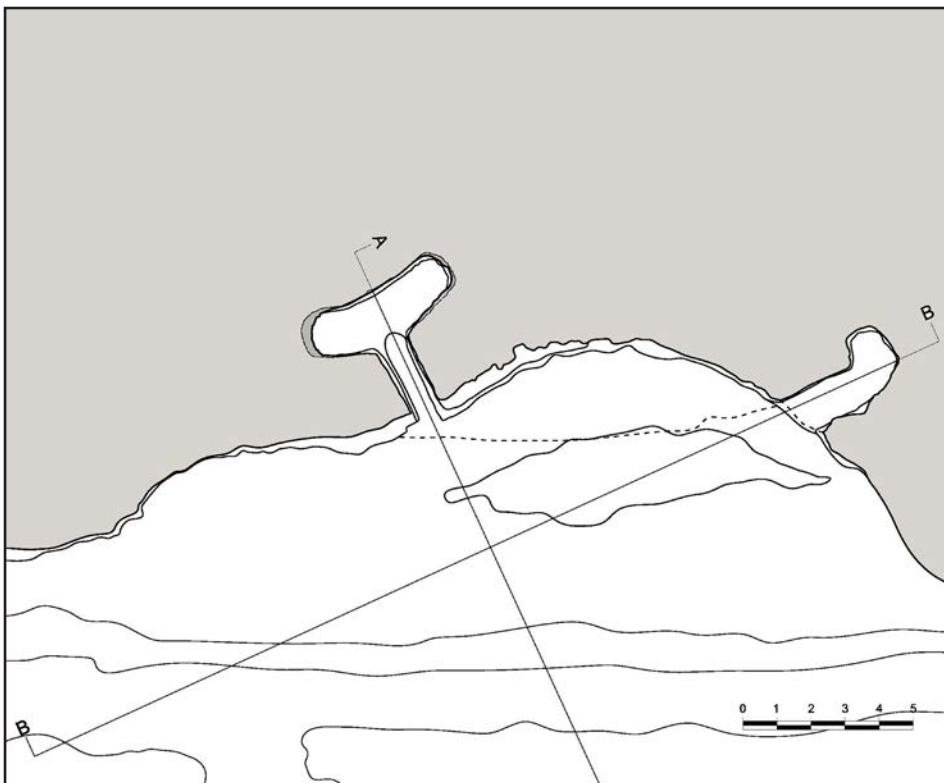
F. Stilo, Caforchì, pianta parete, 2020.
